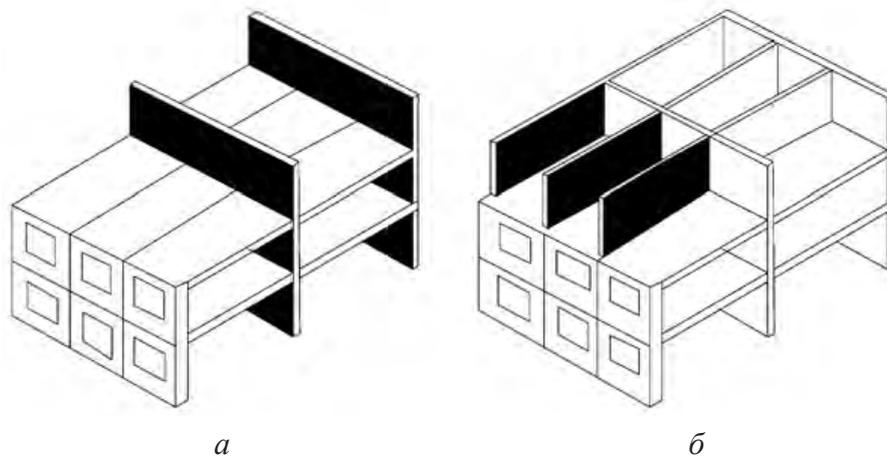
Конструктивные типы бескаркасных крупнопанельных зданий: *а* — с несущими продольными стенами; *б* — с часторасположенными поперечными стенами
